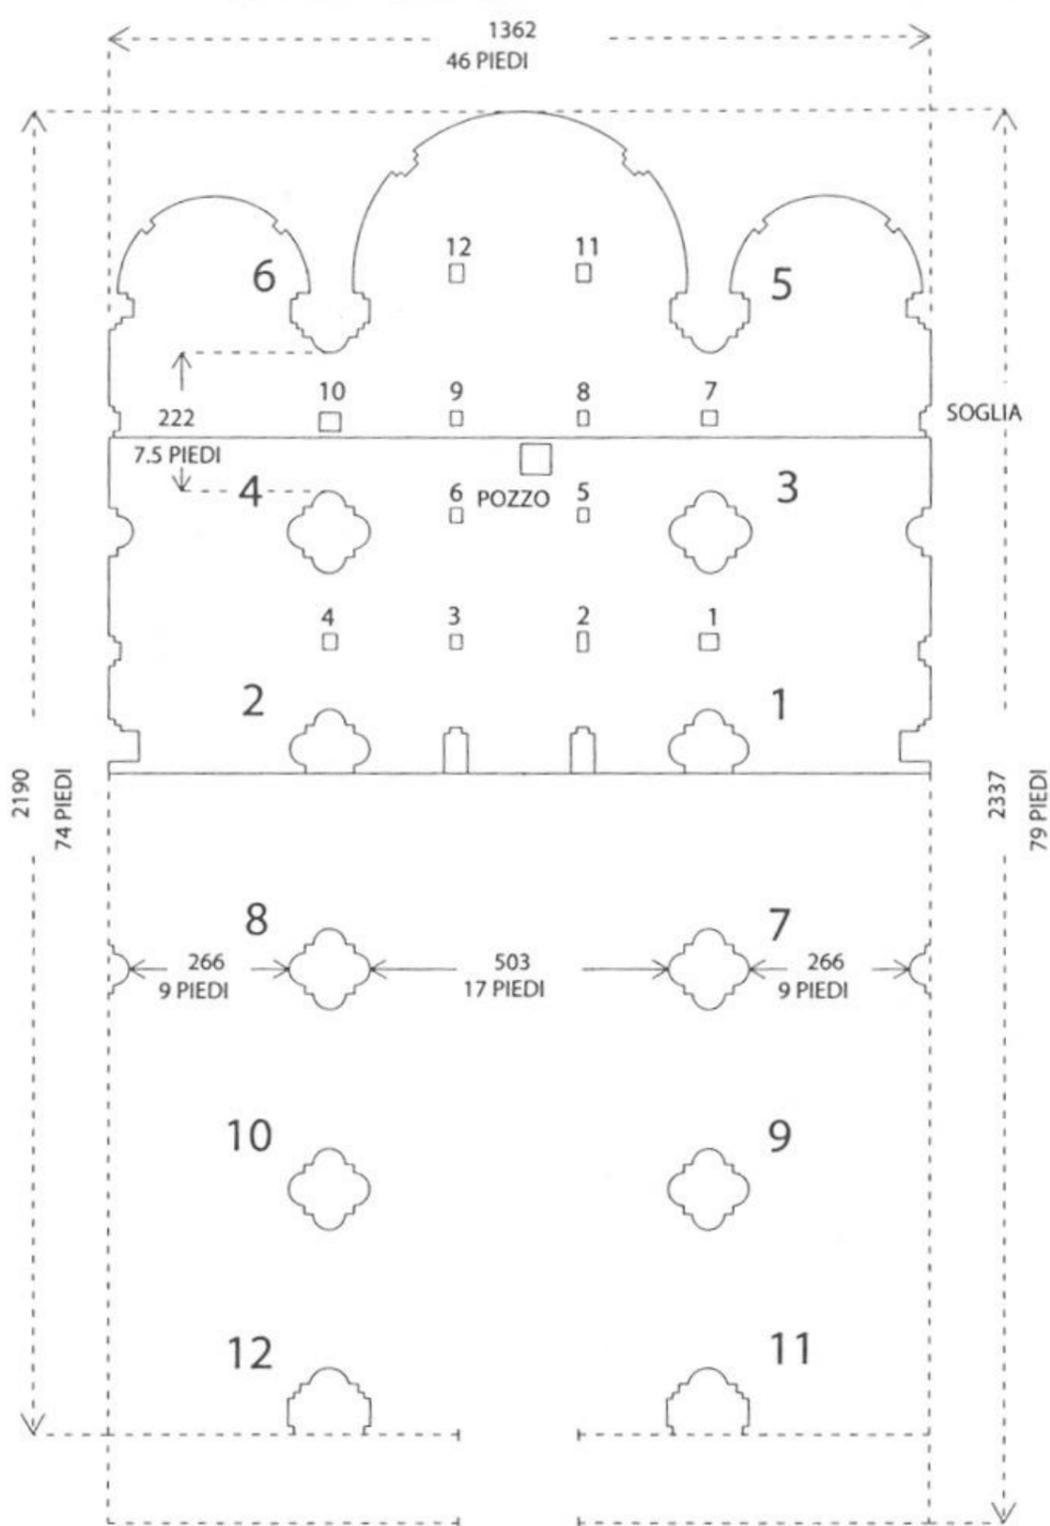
Pianta dell'antica basilica (VIII sec.) e della cripta (XI sec.)
